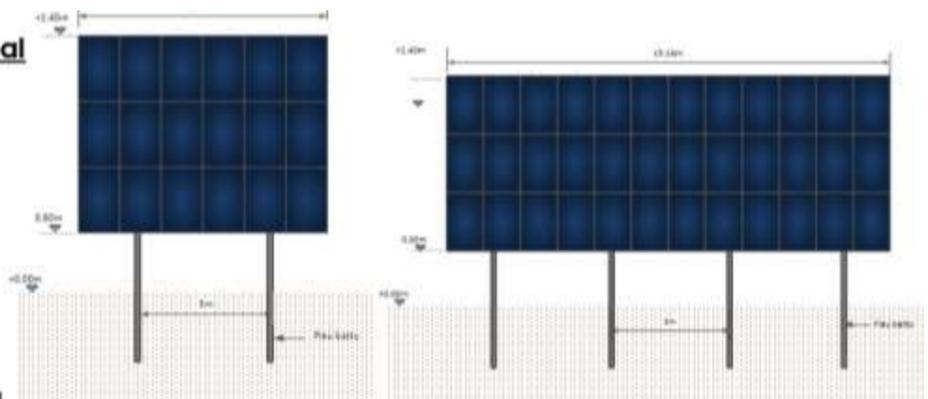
Plan en coupe des tables : casiers 1-2-3
